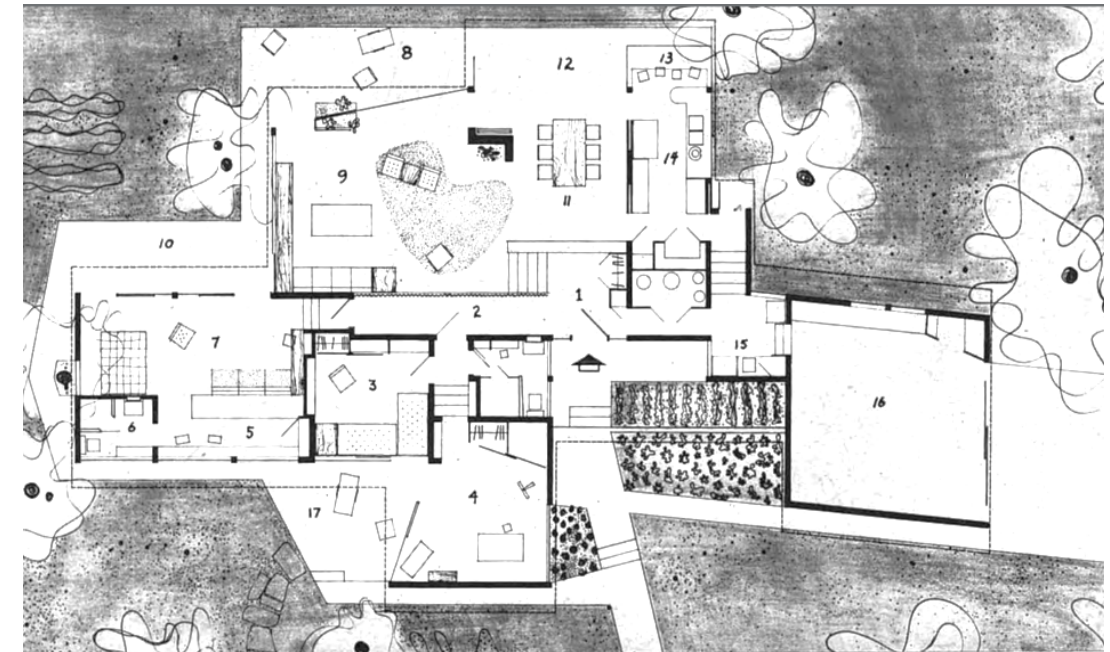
Planta de la Case Study House n.º 10 (Nomland Kemper, 1947). Plano de planta.
